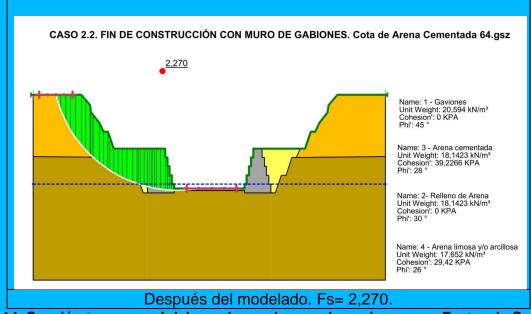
Sección transversal del canal con el muro de gaviones con Factor de Seguridad de Falla Global.
